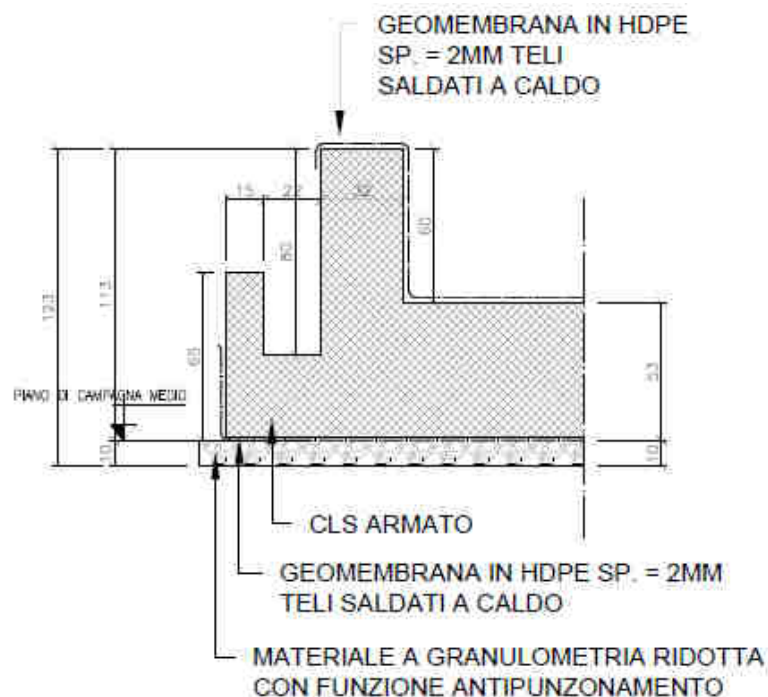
Particolare piazzola di stoccaggio balle - canale raccolta acque meteoriche
